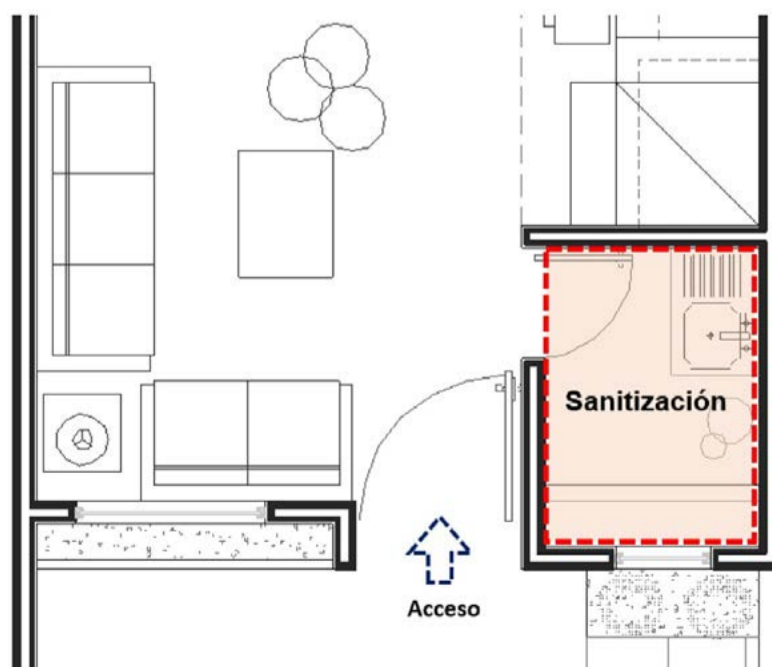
Planta arquitectónica de acceso a una vivienda con espacio para sanitización. Fuente: elaboración propia.
